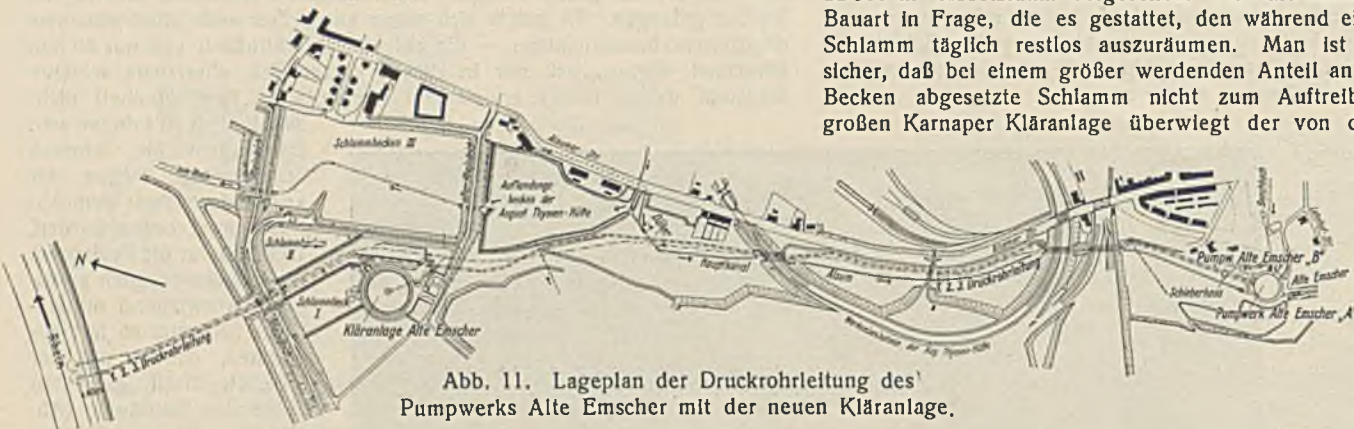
Lageplan der Druckrohrleitung des Pumpwerks Alte Emscher mit der neuen Kläranlage.
